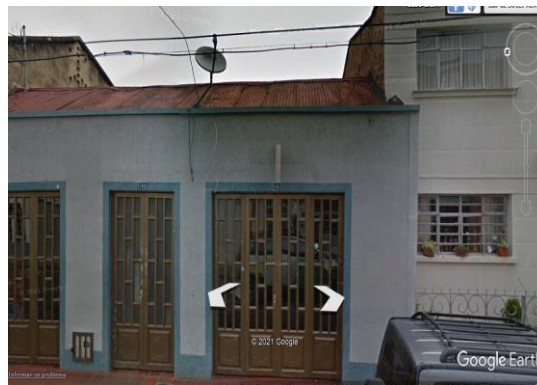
obra de Construcción a demoler en la Carrera 4 N°1-64 Fuente Google Earth (2021)
